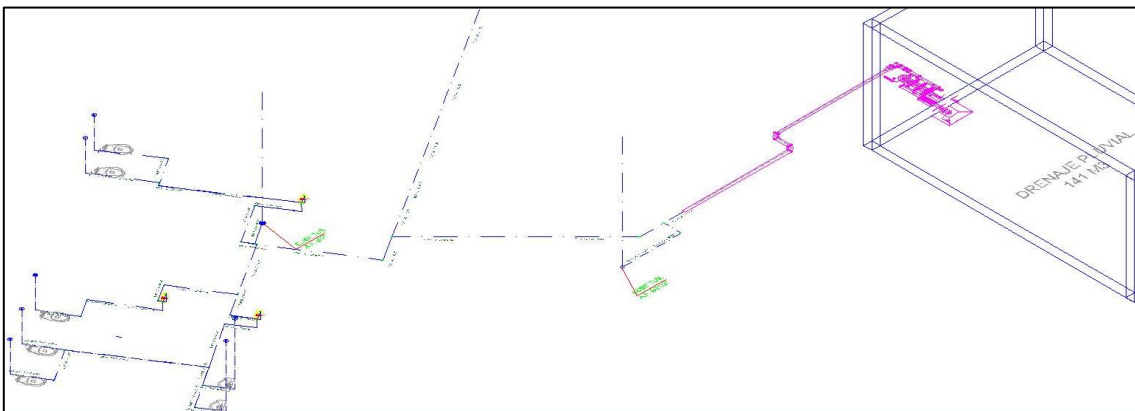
Plano de sistema de drenaje. Fuente: EE.TT. de UNIQ
